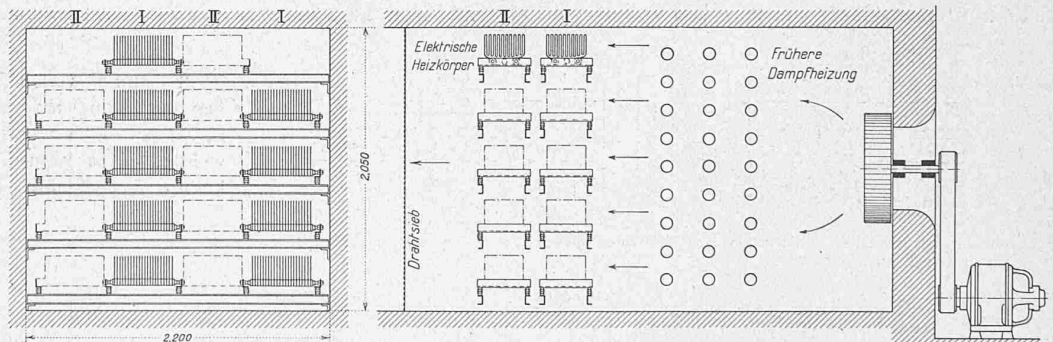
Einbau elektrischer Heizkörper in einer bestehenden Dampfheizkammer. — Masstab 1:50.
